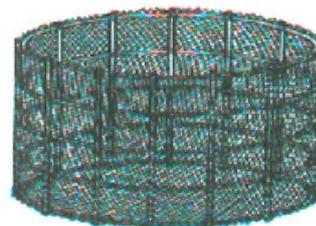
A técnica de construção em ferrocimento (Fonte: PERMACOLETIVO, 2008).
